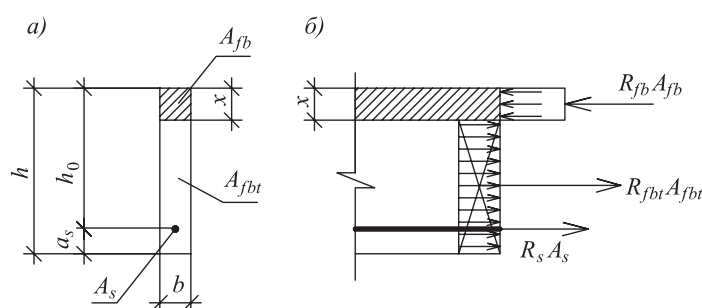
Схемы к расчету нормального сечения сталефиброжелезобетонного изгибаемого элемента
